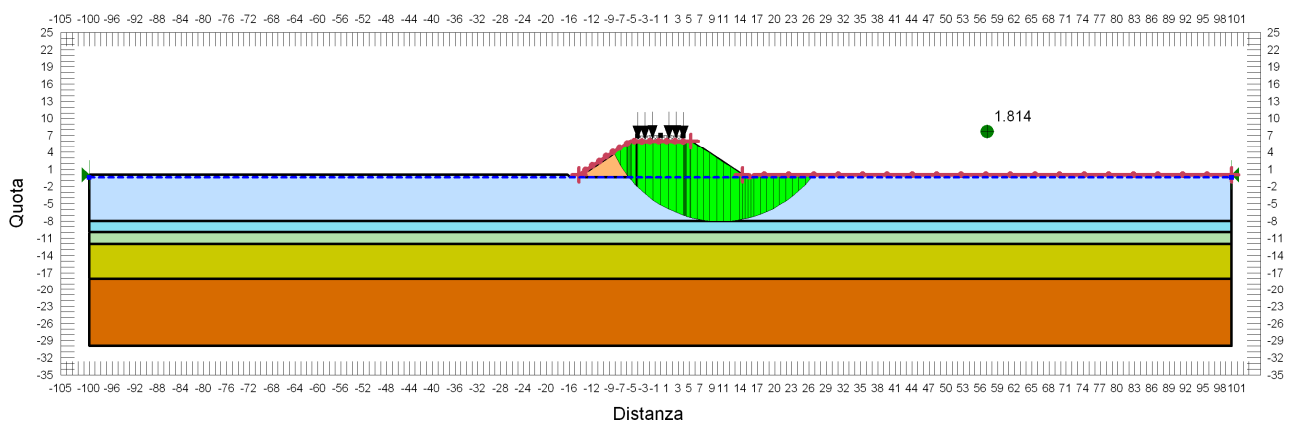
VERIFICA DI STABILITÀ GLOBALE RILEVATO DI H=6.00 M - CONDIZIONE STATICA NON DRENATA.
